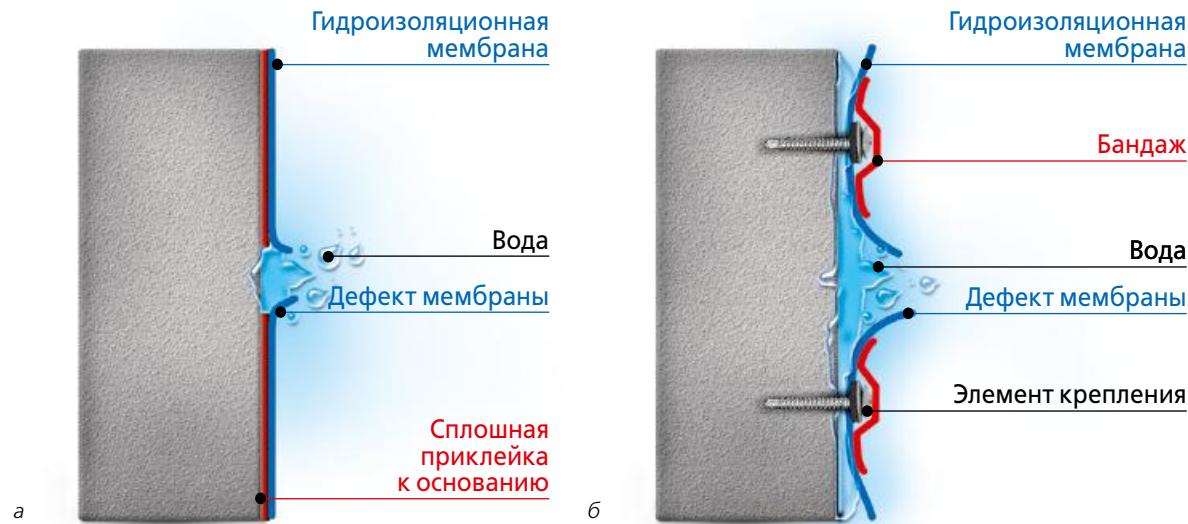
Влияние возможного дефекта на надежность гидроизоляционной мембранны при различных способах укладки:
